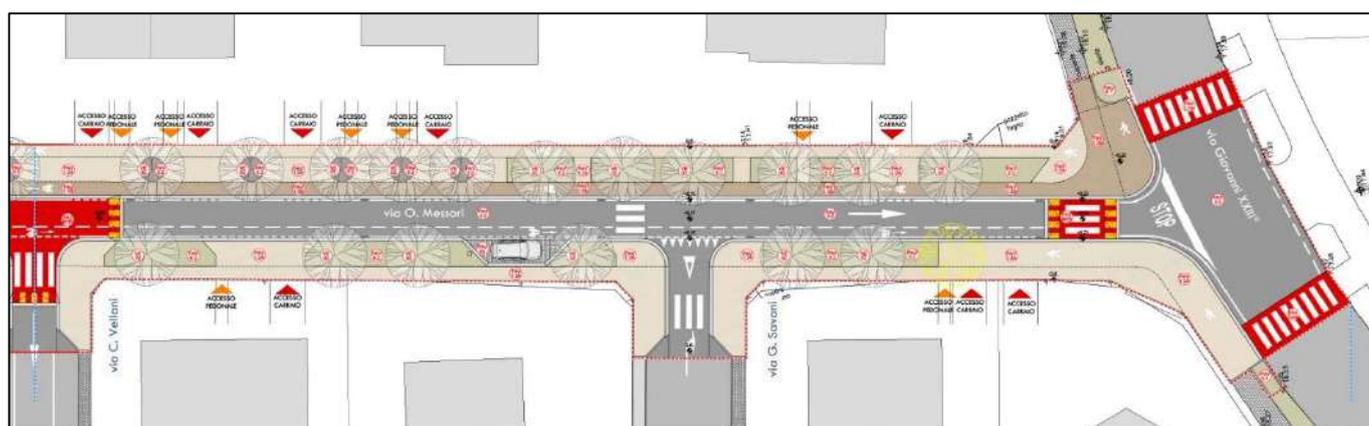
estratto planimetria di progetto intersezione via Messori-via Giovanni XXIII°
